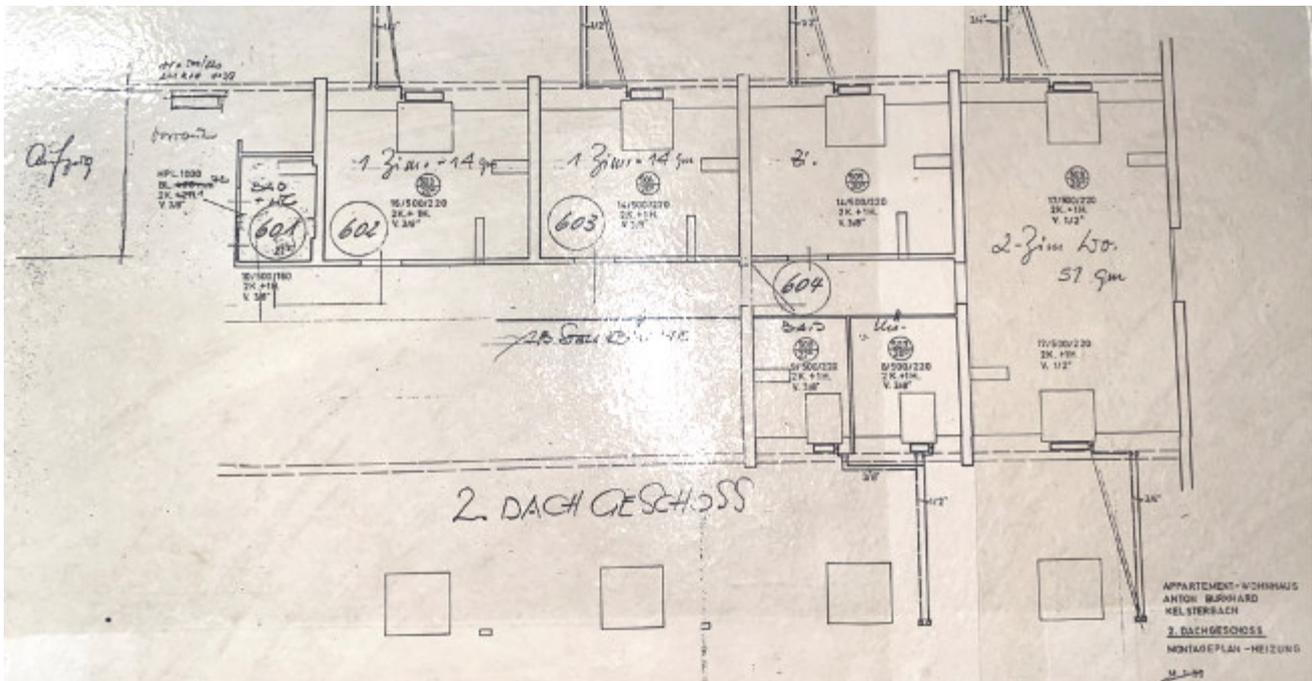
Foto des SV; Grundriss Dachgeschoss 2. Ebene; Quelle: Montageplan Heizung
